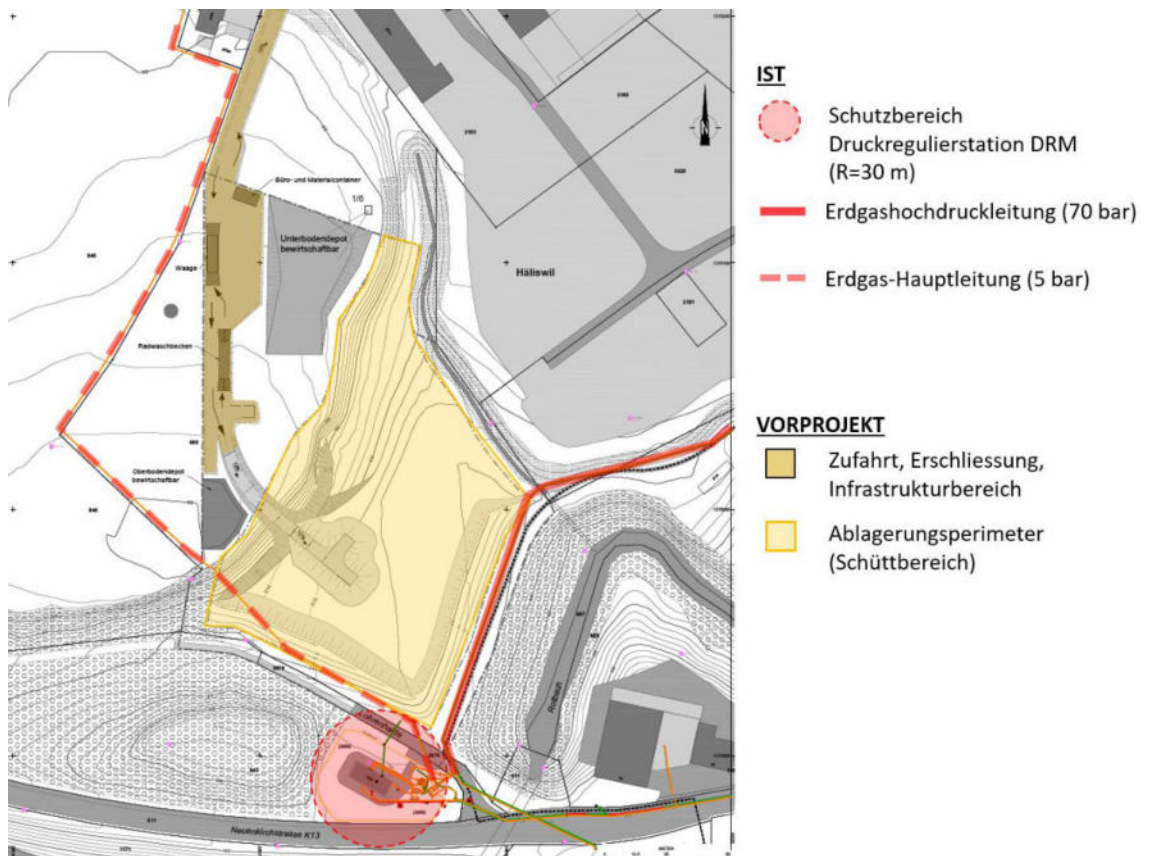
Durch das Deponieprojekt tangierte Erdgasanlagen mit geplanter Zufahrt/Deponieerschliessung von Norden her (Übersichtsskizze, Hintergrund Planbeilage VP-3 «Betriebsplan»)
